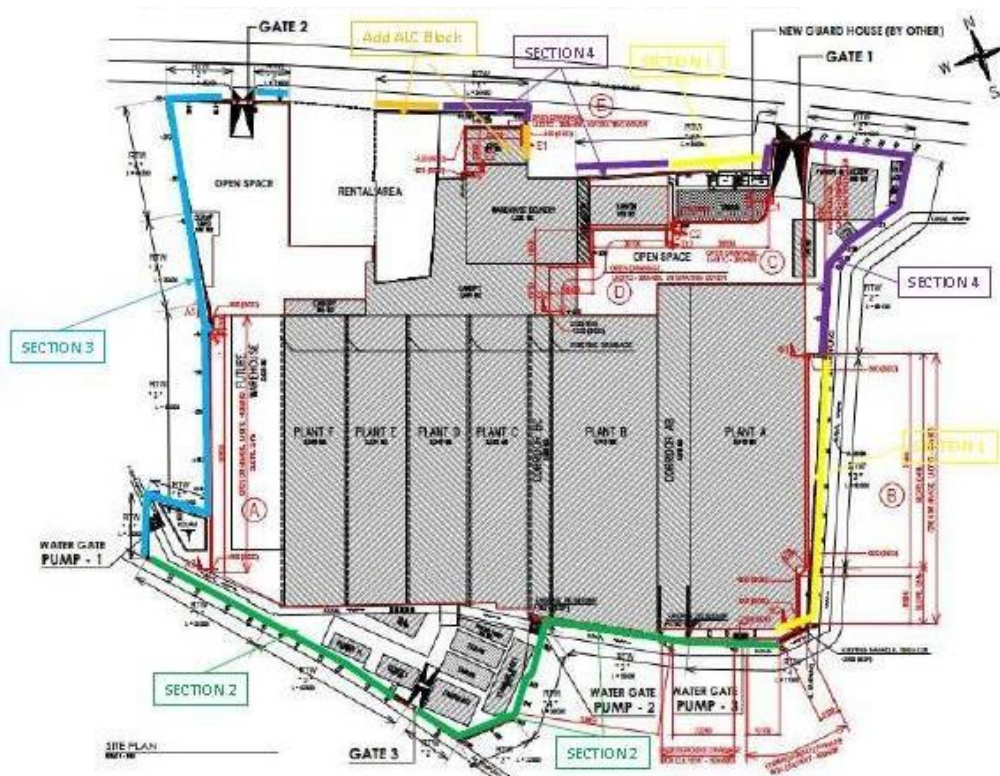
Denah pembuatan dinding retening wall diarea seluruh pagar batas tanah PT. SAI
